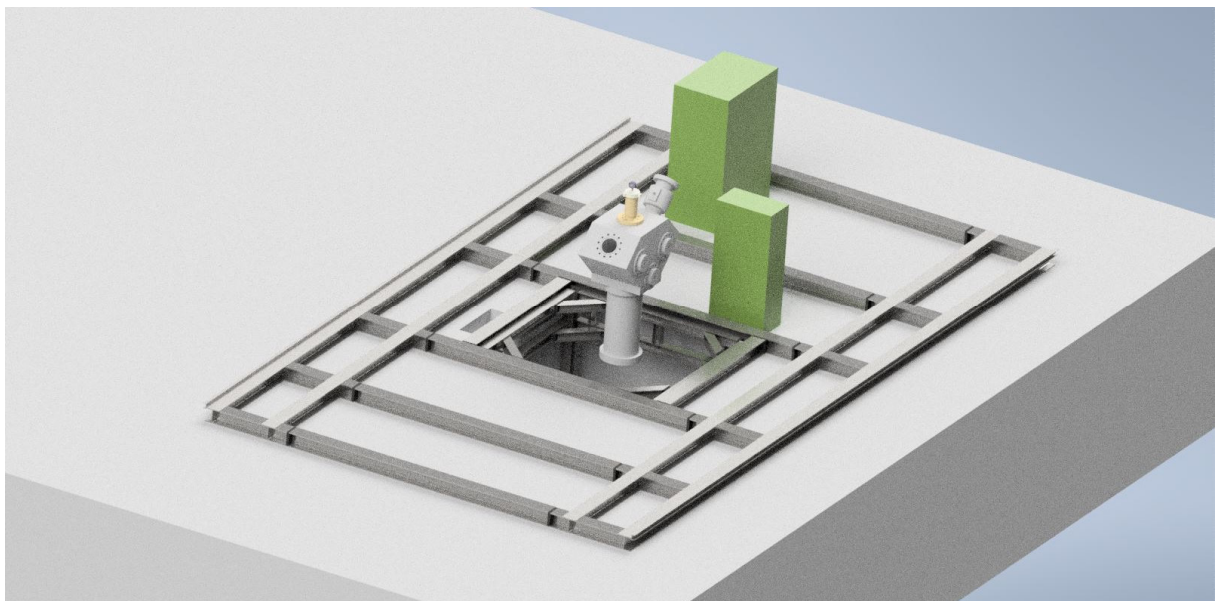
Anschluss Grundrahmen zur Kellerkonstruktion
